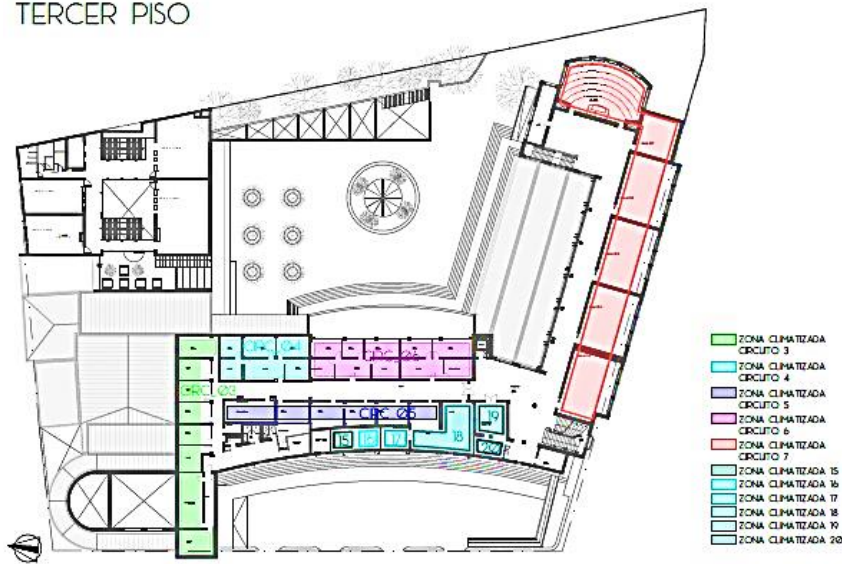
Planta esquema zonas climatizadas Tercer Piso.
